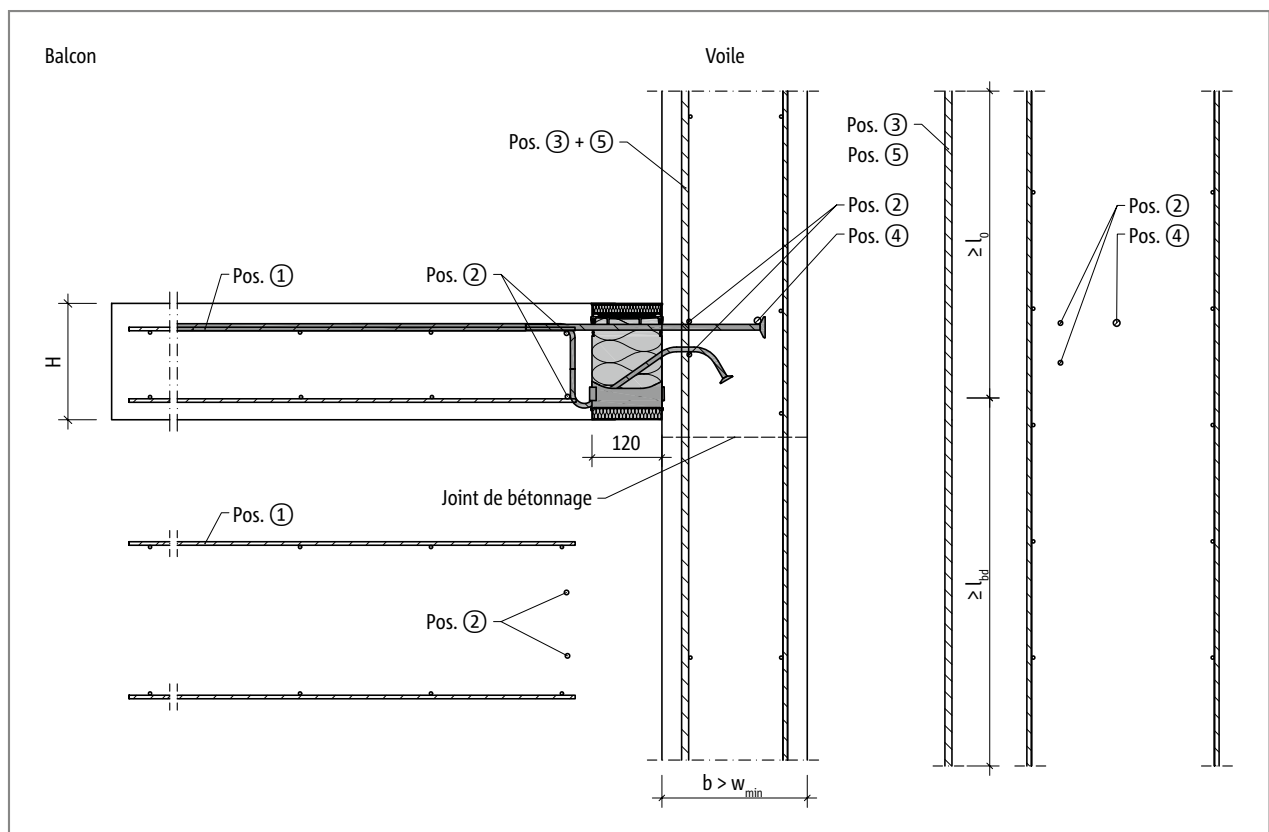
Schöck Isokorb® XT type K-U : Renfort sur site pour connexion murale vers le haut, avec dimensions supérieures des composants ($w_{vorb} > w_{min}$)
